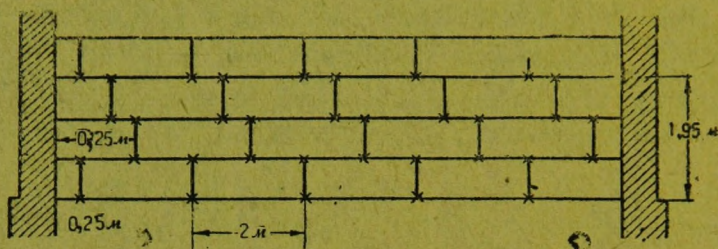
Размещение опалубки со щитами в 0,50 и 2 м. Крестами отмечены отверстия от стяжек
